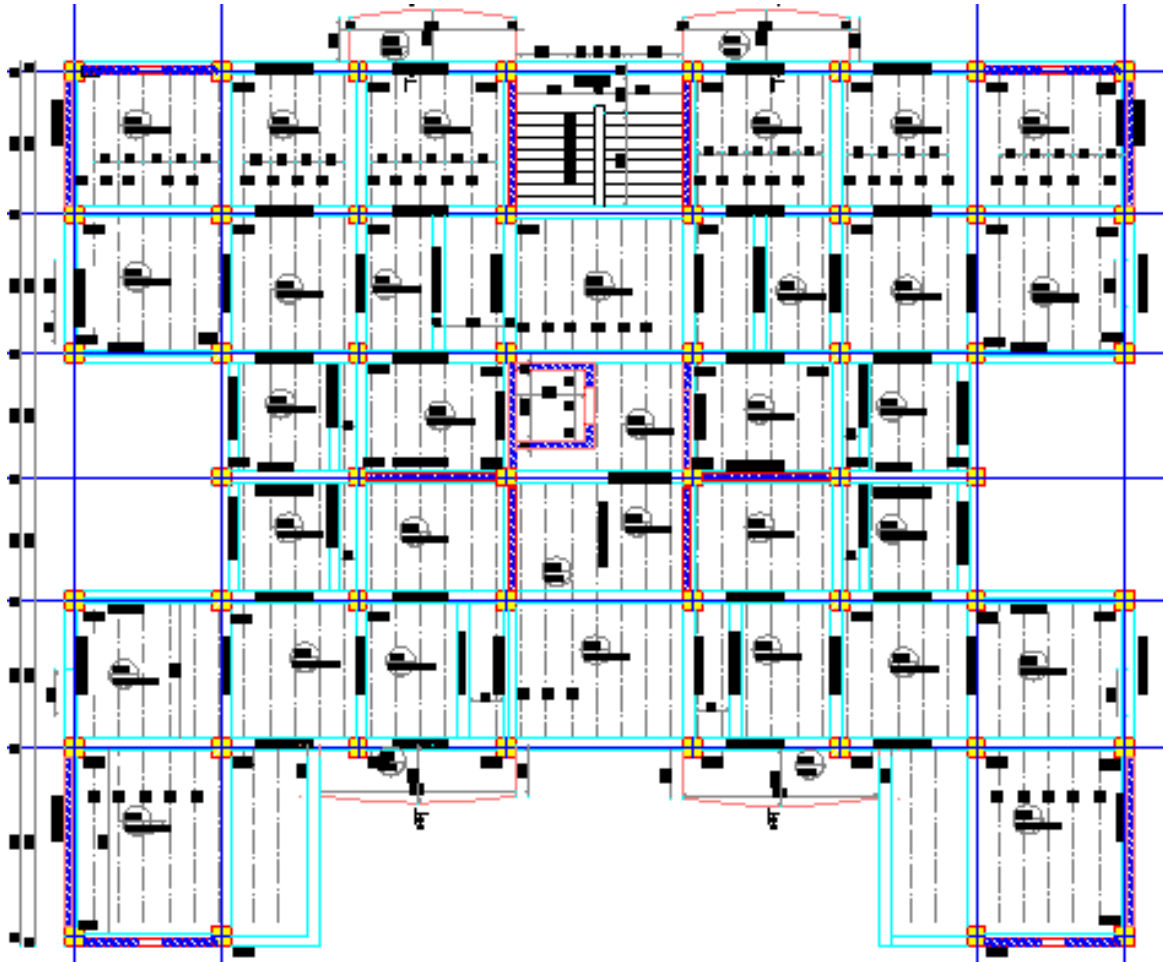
Plan de coffrage de niveau d'étage courant.
